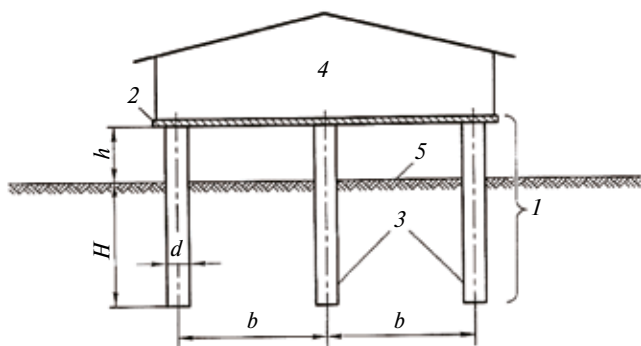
Схема здания на вечной мерзлоте с проветриваемым подпольем предлагаемой конструкции (дизайн второго типа): 1 – свайный фундамент; 2 – плита ростверка; 3 – столбы теплоопоры; 4 – корпус здания; 5 – естественная поверхность грунта
